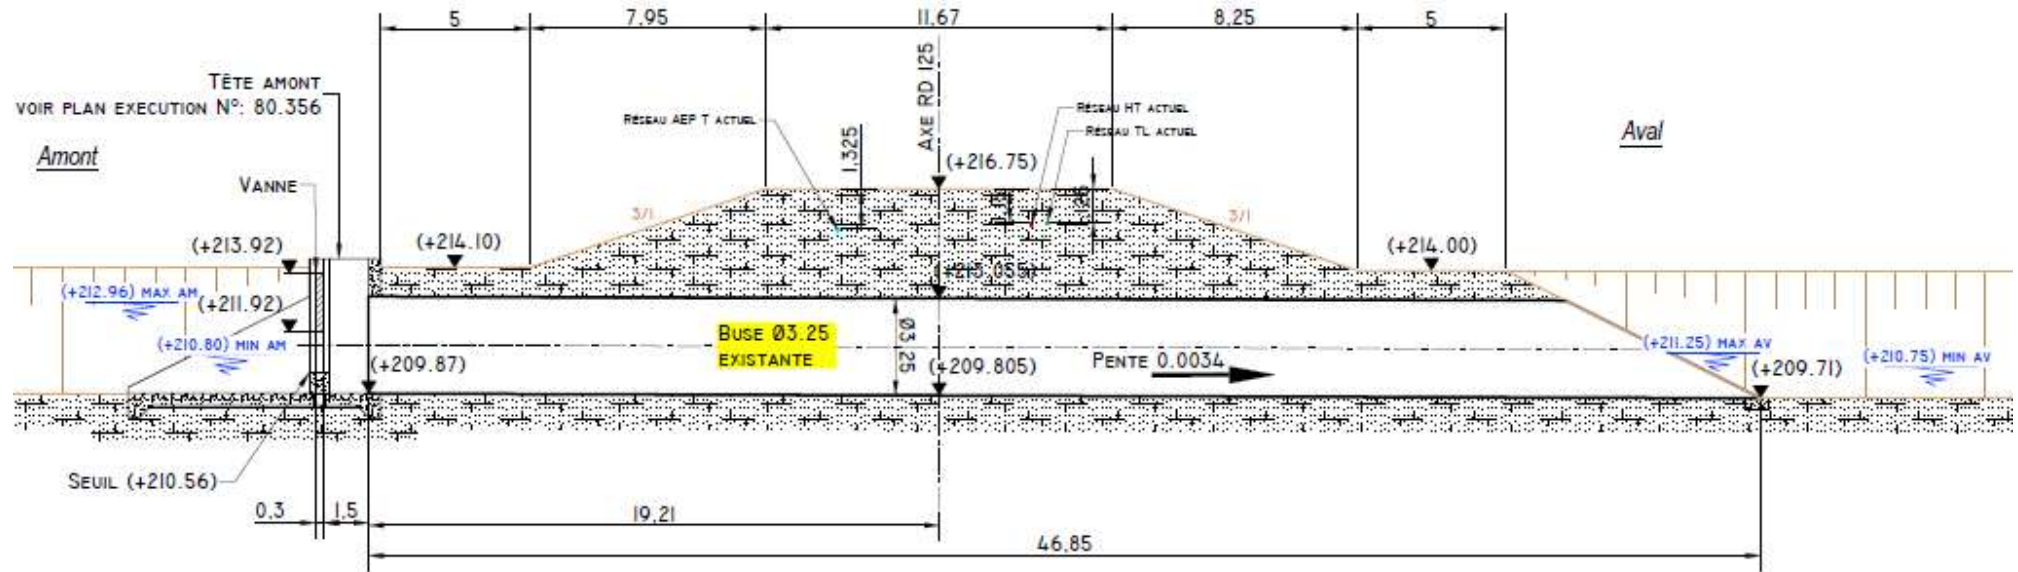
Profil en long de l'ouvrage à l'état existant.
